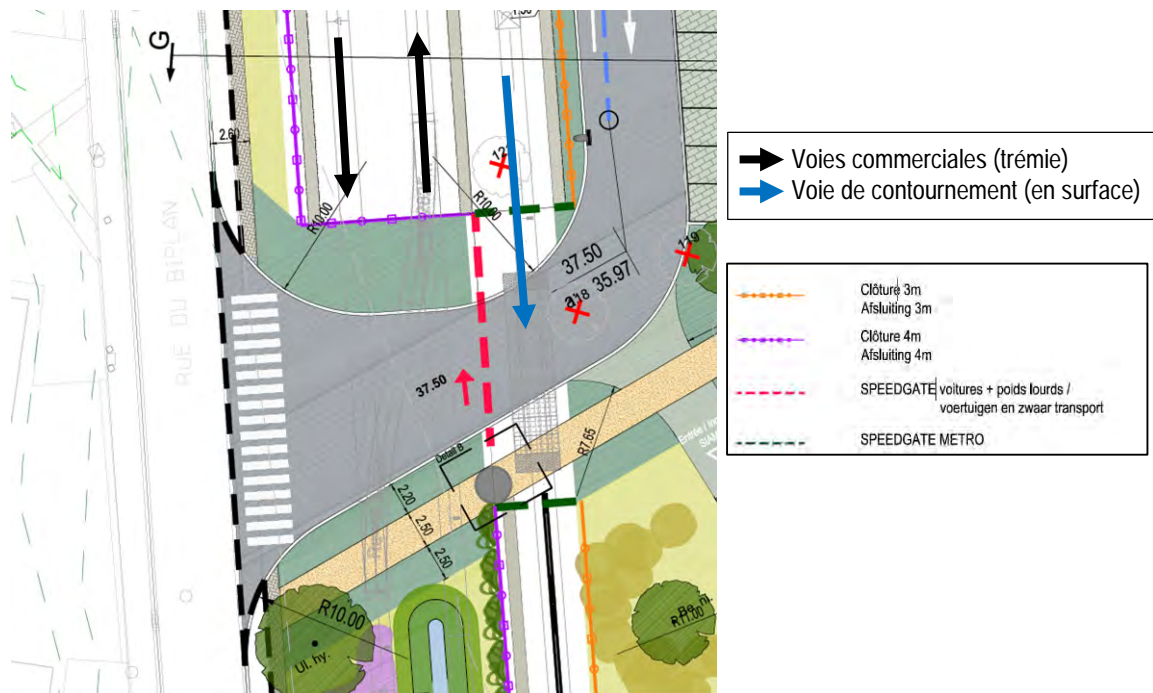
Vue sur le futur croisement entre l'accès au parking du dépôt métro et la voie de contournement (BMN, 2018)
